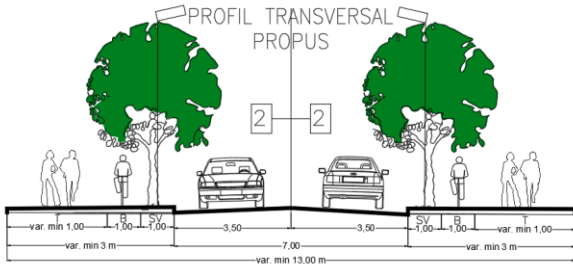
Profil transversal propus pentru artere secundare de circulație
